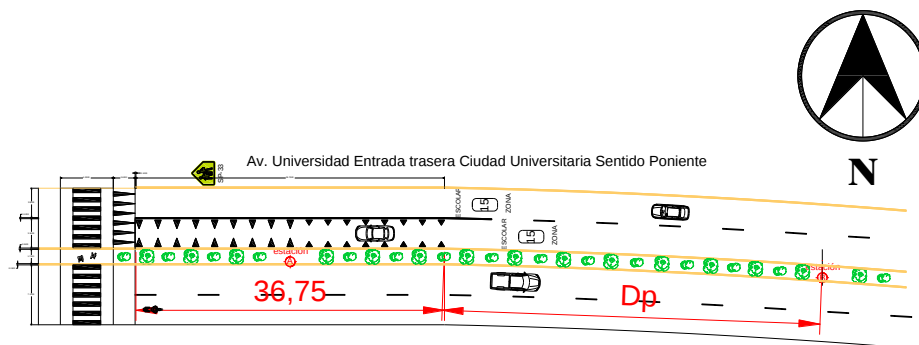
Planta geométrica de la zona escolar 02. Elaboración propia
